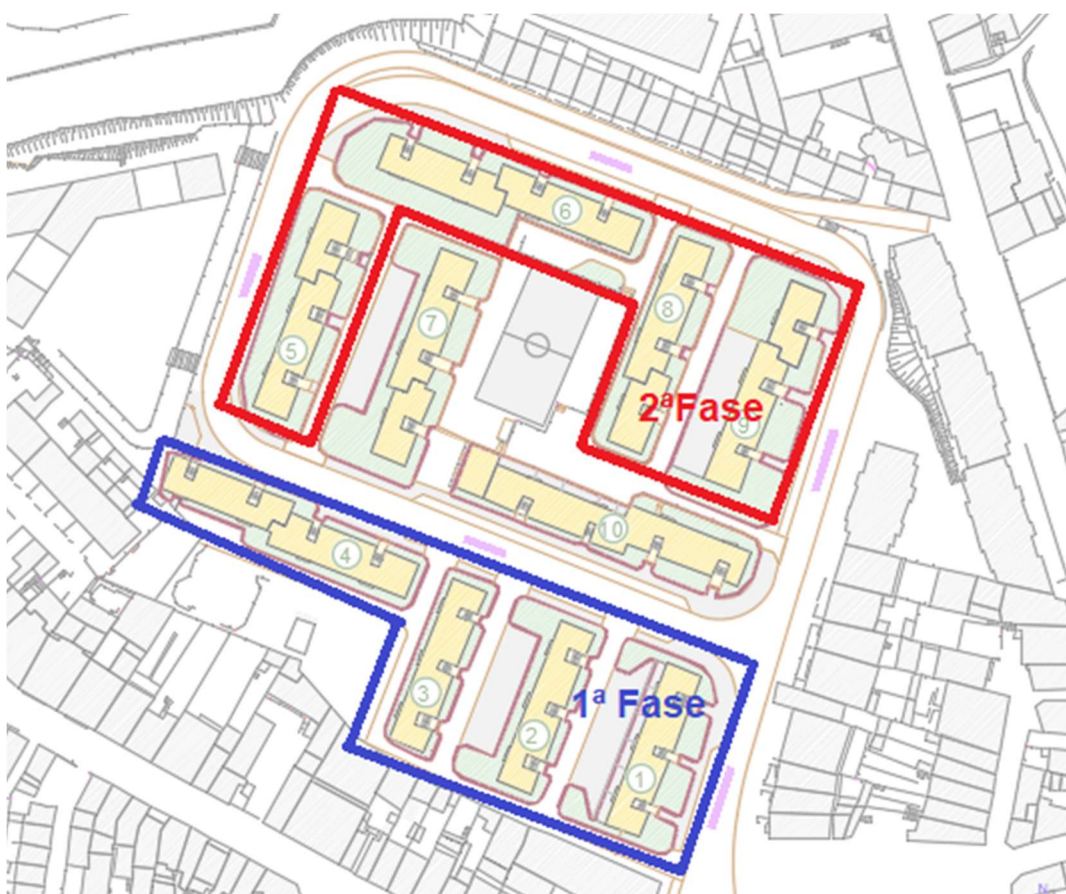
Planta geral da obra caso de estudo (adaptado de Projeto de Execução da Obra Caso de Estudo)
